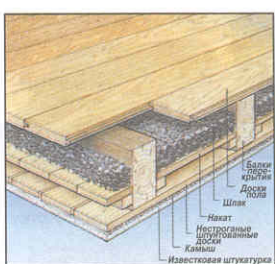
Классический пример пола мансарды. Сосновые доски покрытия пола уложены прямо на балки перекрытия без звукоизоляции. Шум от шагов по полу передается через балки на нижние элементы конструкции пола и далее вниз.
